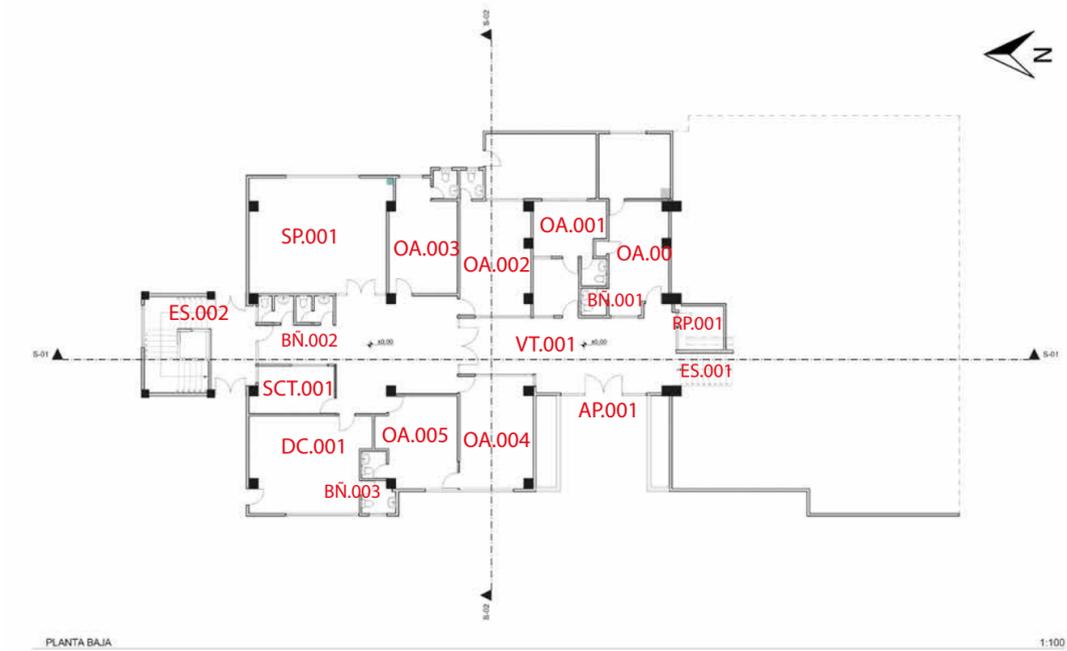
Codificación Planta Baja. Fuente: Elaboración propia
